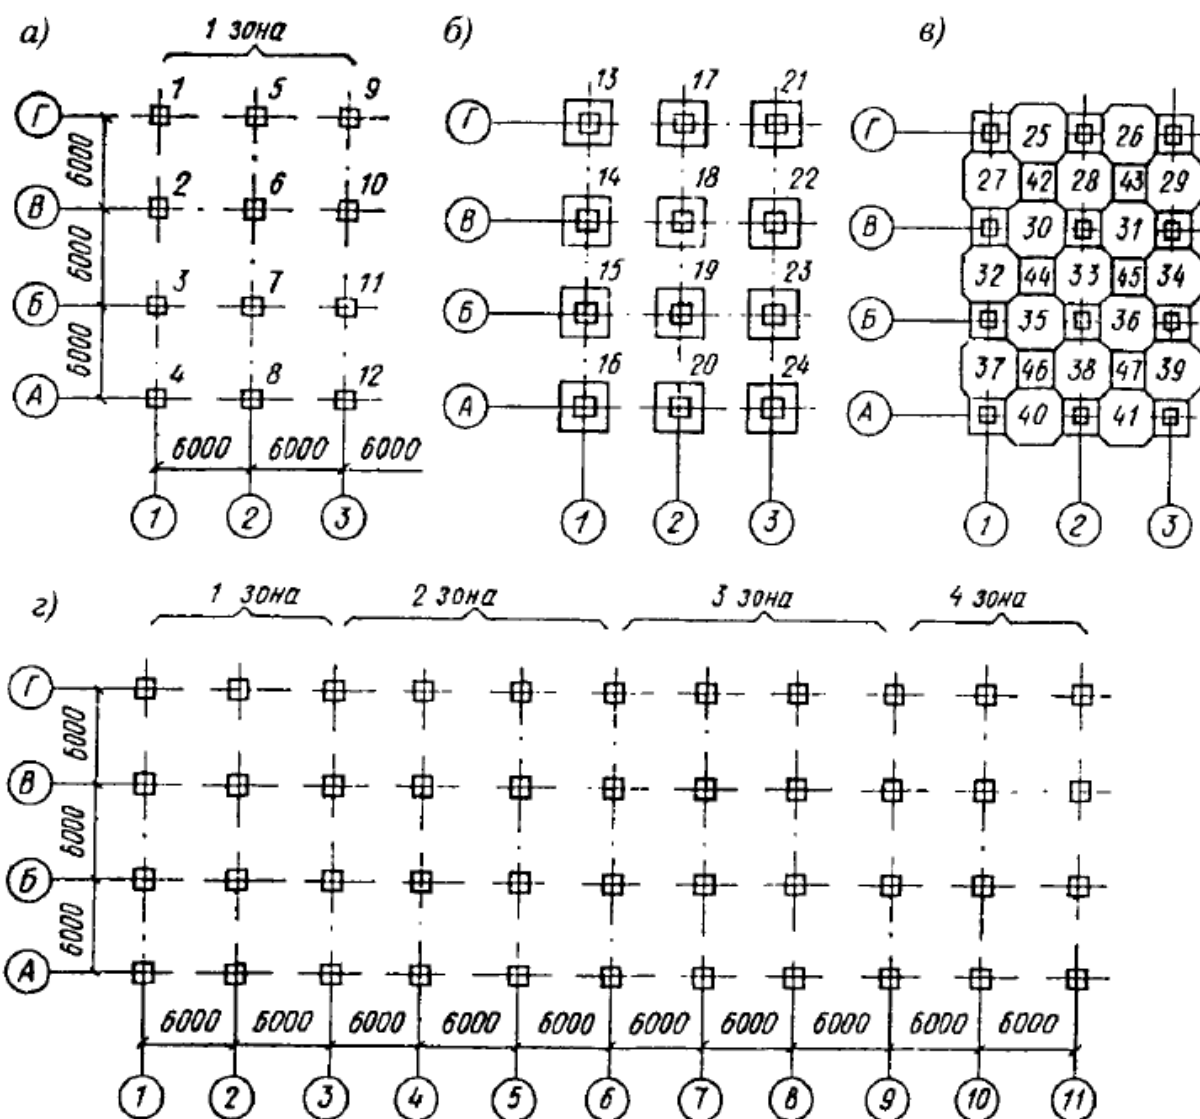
Технологическая последовательность монтажа каркаса здания с безбалочными перекрытиями: а — установка колонн; б — укладка капителей; в — укладка межколонных и пролетных плит; г — зоны монтажа конструкций
